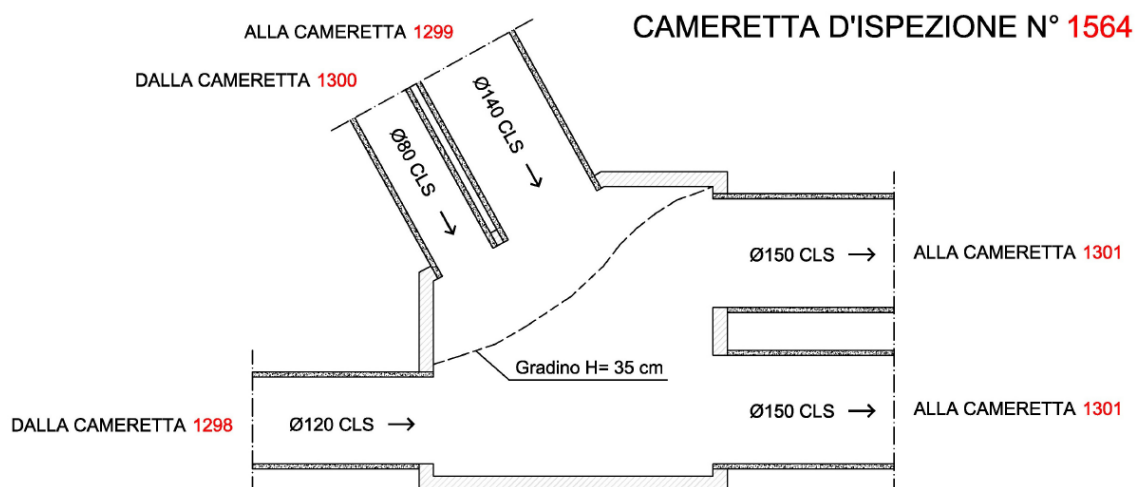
Cameretta d'ispezione n° 1564 situata a monte dell'attraversamento del canale Villoresi
